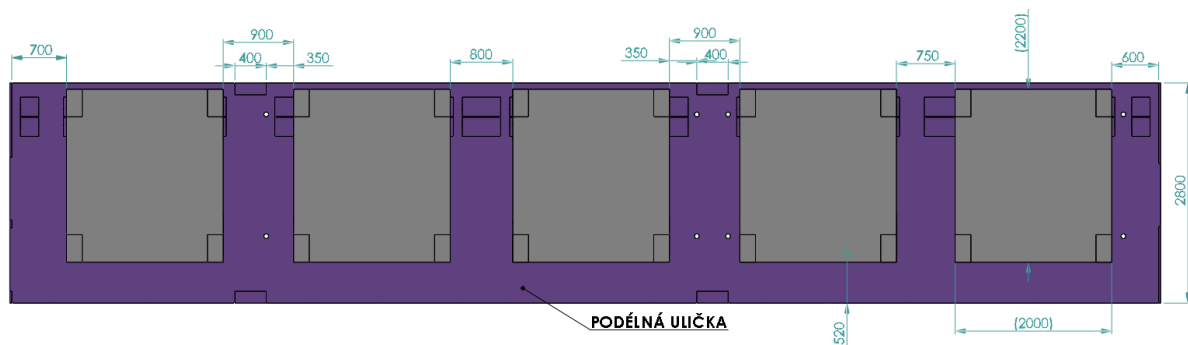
Hrubá stavební struktura - detail zahloubení pro kola
